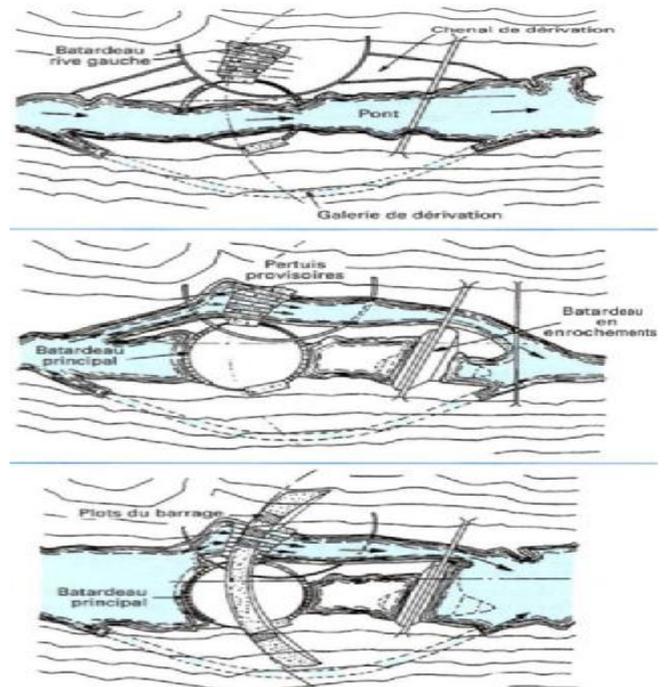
Batardeaux du chantier du barrage de Kariba(Zambie) (technique de l'ingénieur)
